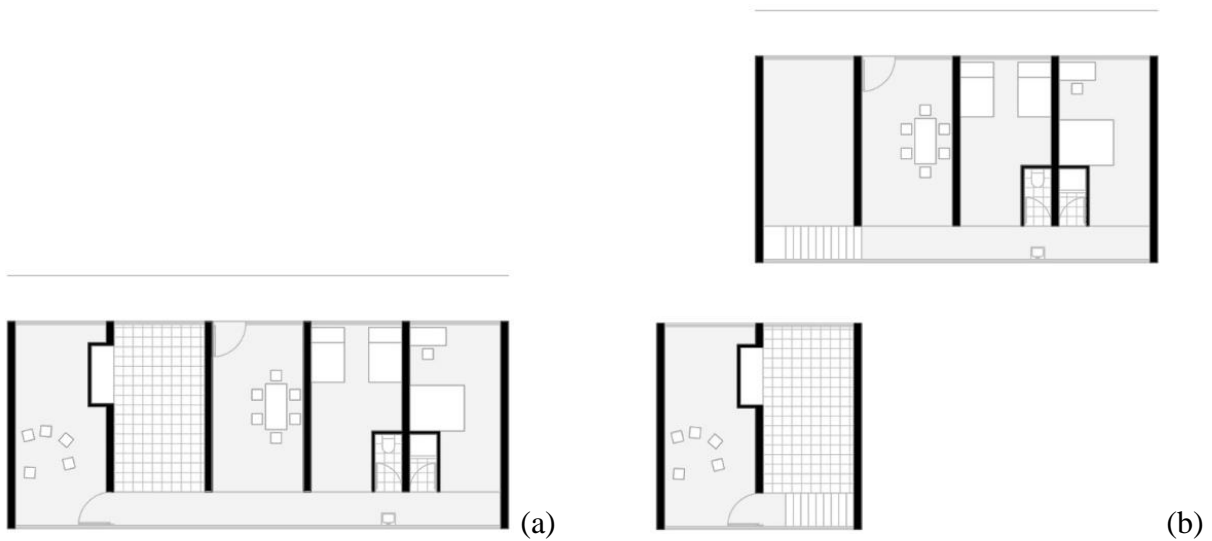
Posibles tipologías (a) (b). Fuente: Plusarq
